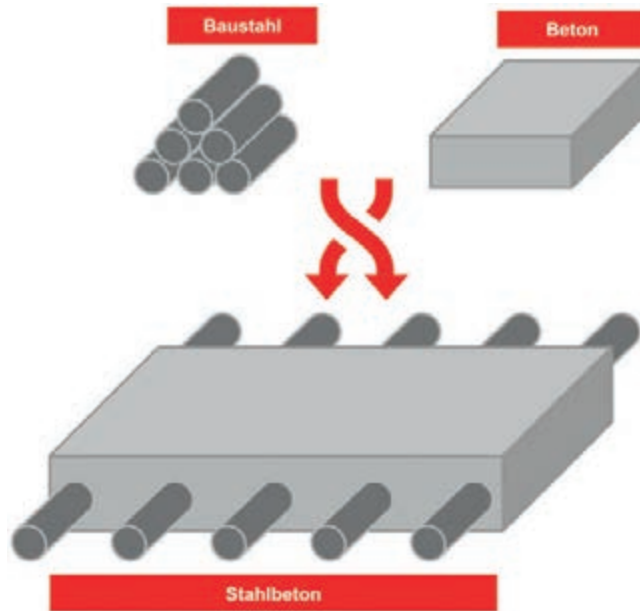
Prinzipdarstellung des Verbundes Stahlbeton bestehend aus den Einzelwerkstoffen Baustahl und Beton.
